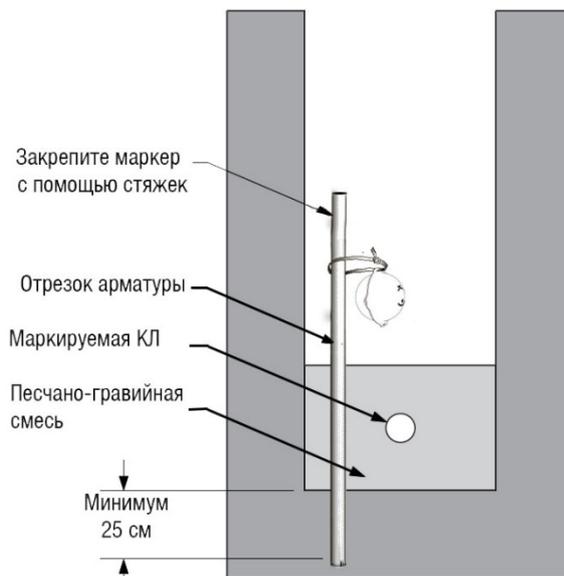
Установка маркера OtiniMarker с креплением к вертикальному стержню
